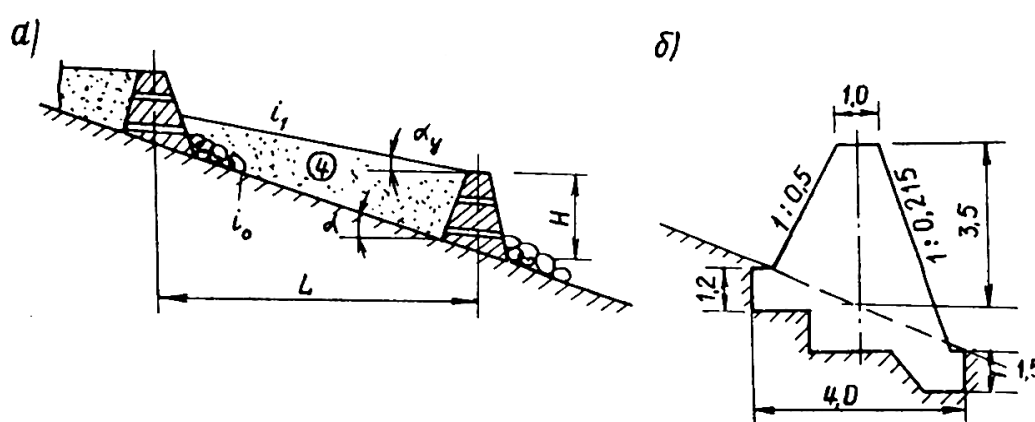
Система барражей; а – каскад барражей; б – поперечное сечение барража [2]
